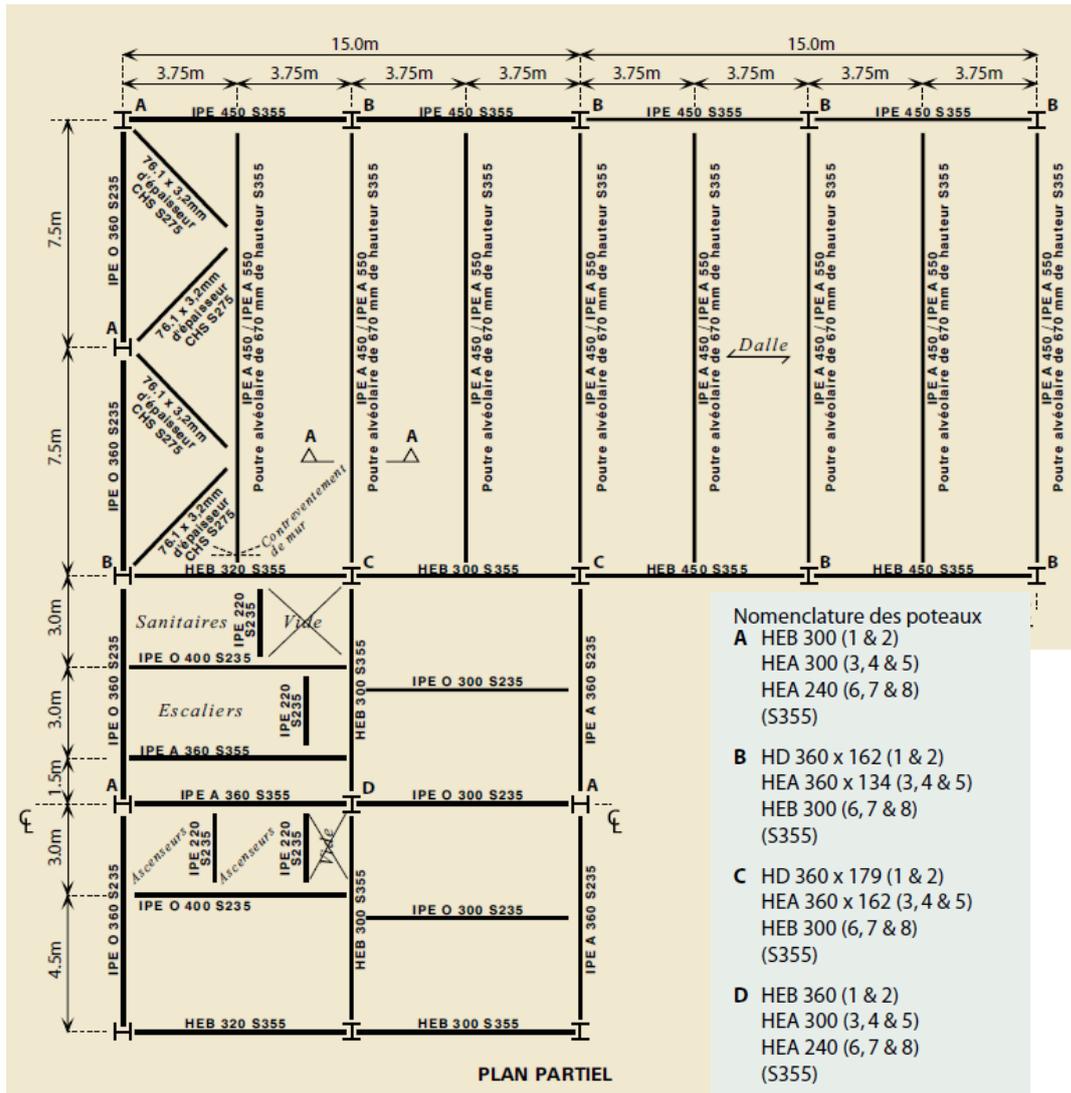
Poutres cellulaires (poutres secondaires de grande portée) – Exemple de disposition d'un angle d'un bâtiment de 8 étages avec un atrium
